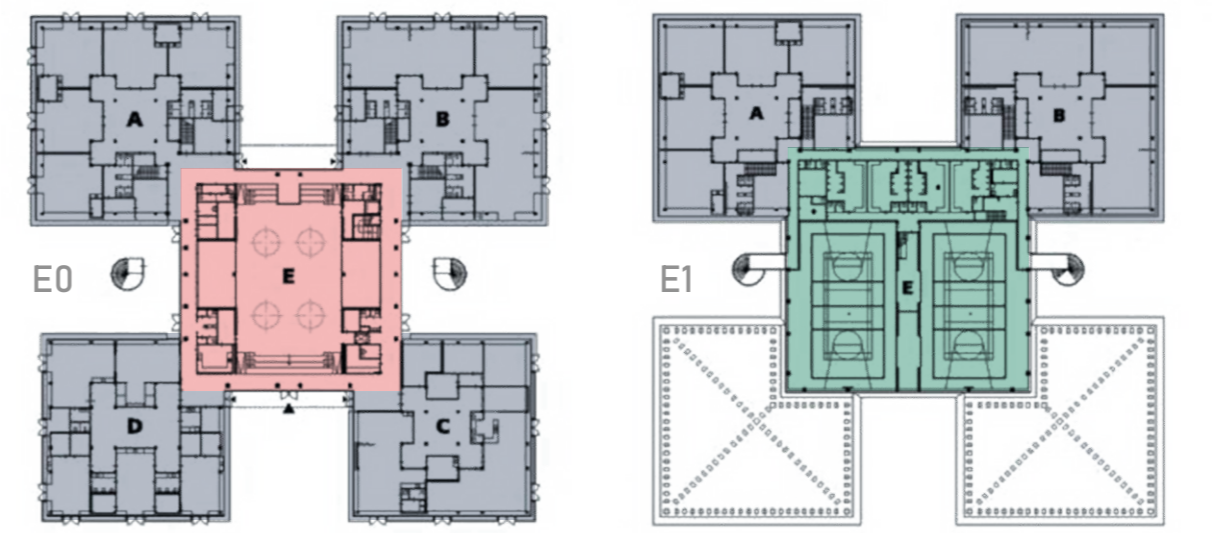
De Matrix Bredeschool: Grundriss, Schnitt
